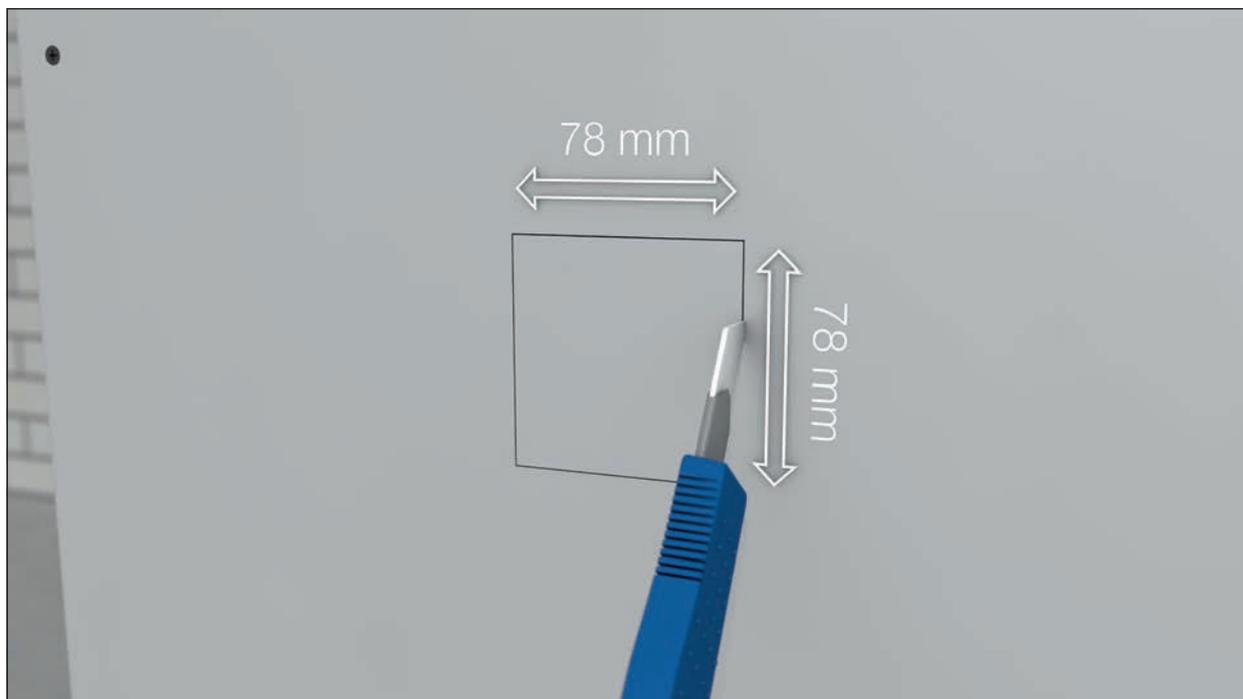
Mit einem Cuttermesser wird ein rechteckiger Ausschnitt ausgeschnitten.
